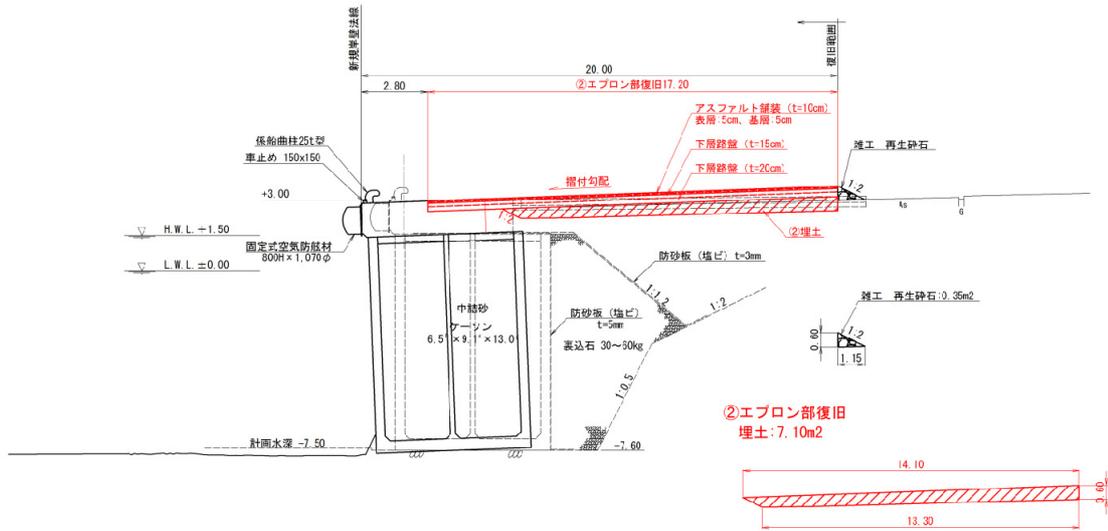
No.7 日立港区_第2ふ頭地区 2-D 岸壁 (-7.5m) の断面図 No.2 (復旧後)
